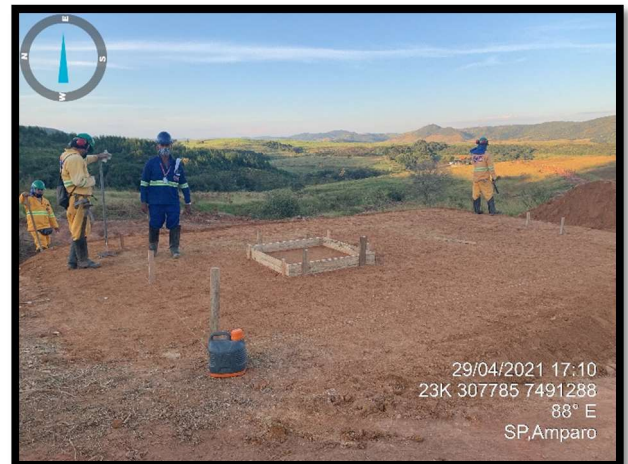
Preparação do local para instalação da EMA. Abr./2021
